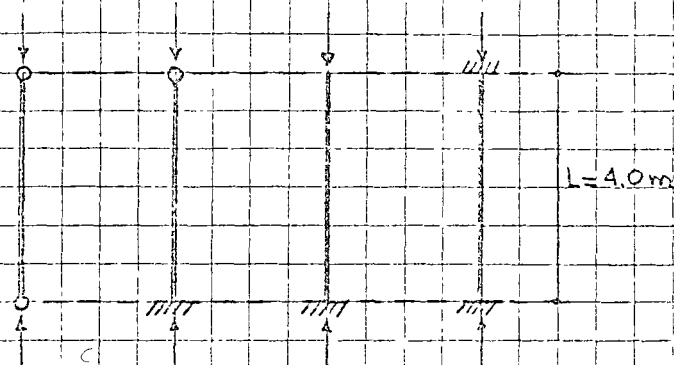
SECCIÓN TRANSVERSAL Y CONDICIONES DE APoyo DE LAS COLUMNAS DEL EJEMPLO 4.4.
